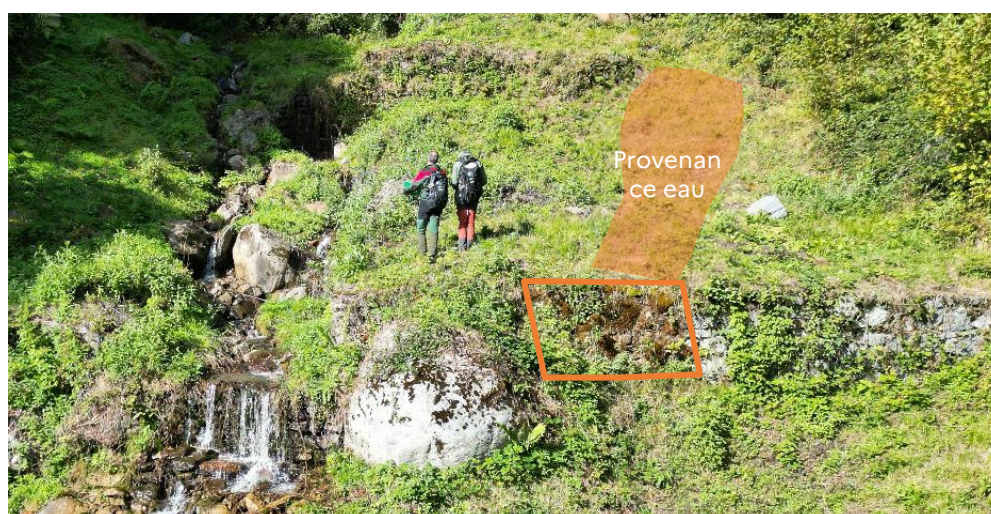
Photo drone du seuil n°16 avec repérage des venues d'eau et de la future tranchée drainante
